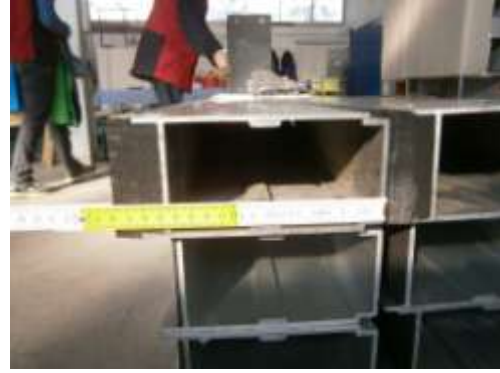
Dammbalkenelemente, gelagerte Profile
